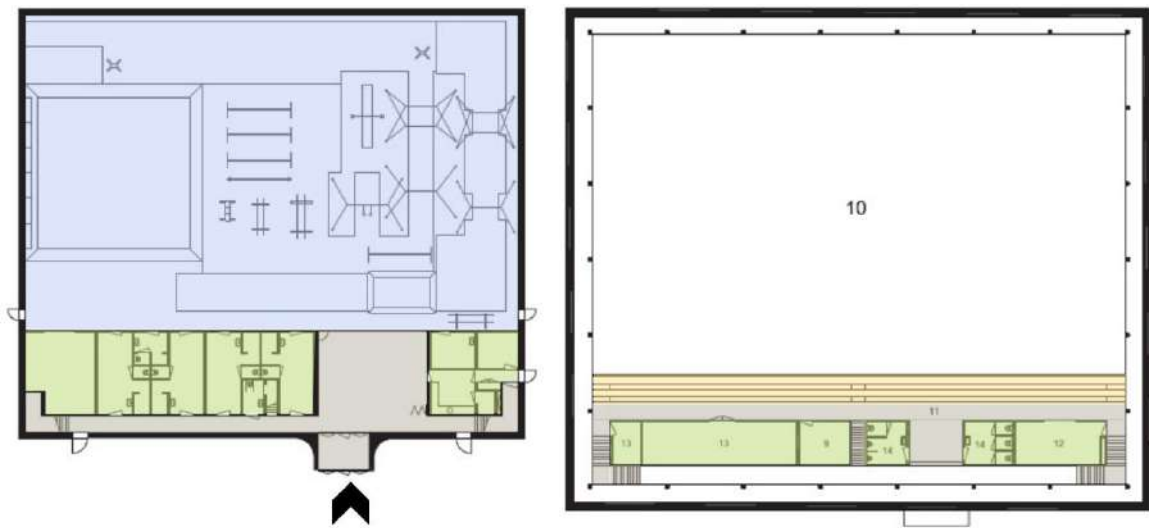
Plantas térrea e segundo pavimento / Fonte: Archdaily
